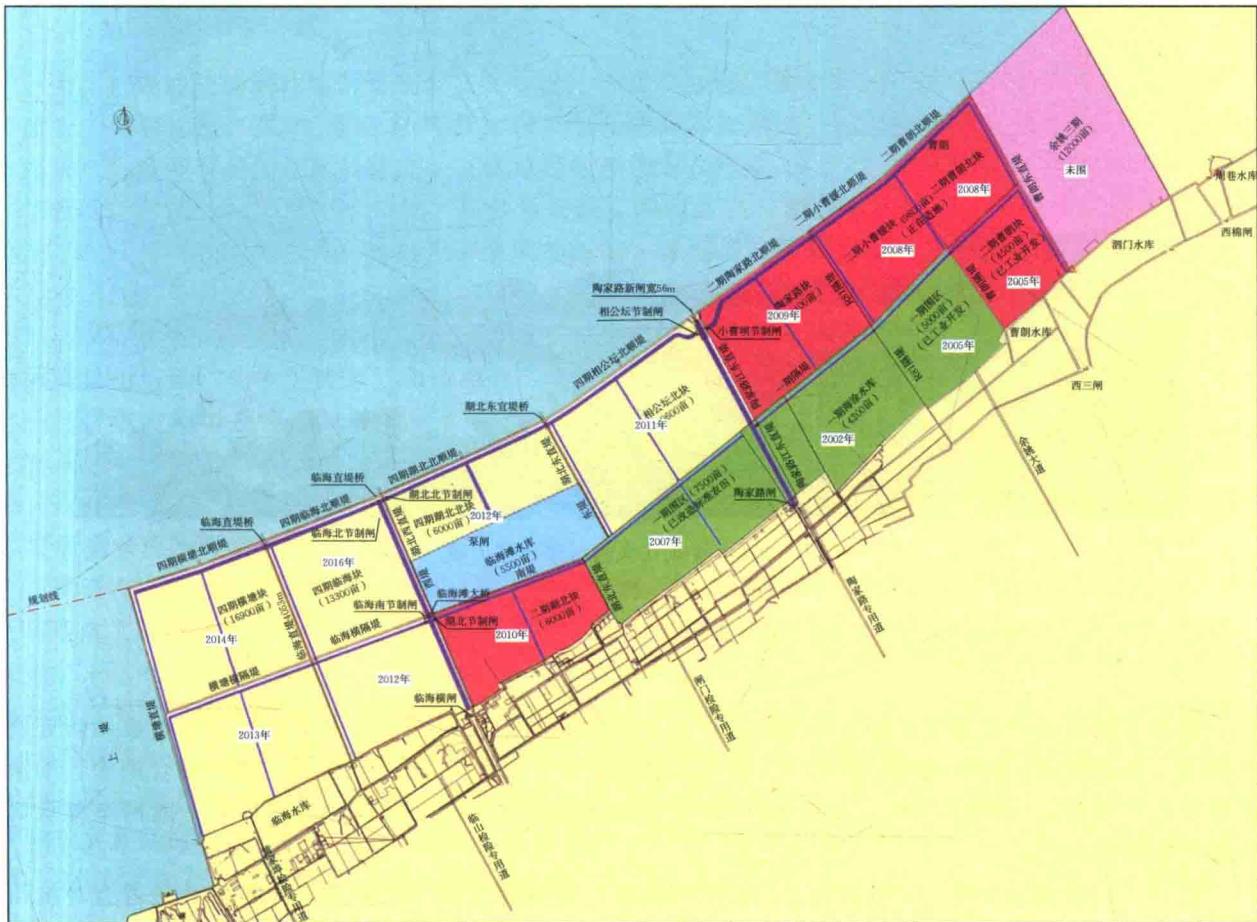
余姚岸段促淤围涂工程总平面布置图
